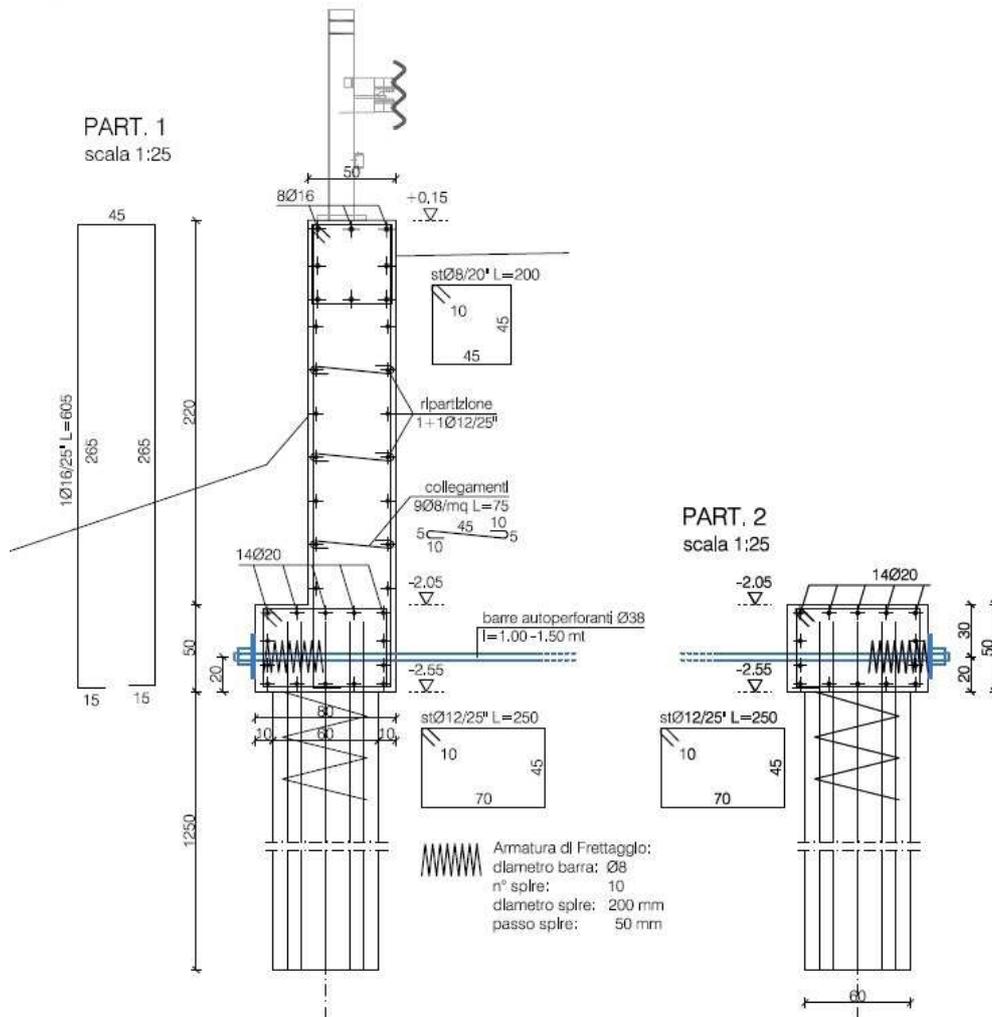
Sezione tipo del cordolo e del muretto dell’opera di consolidamento con barriera stradale
